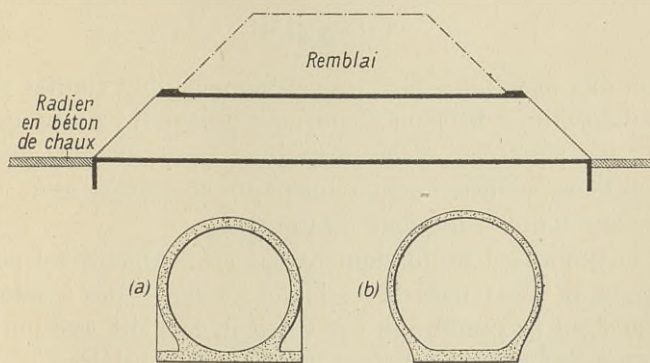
Coupe longitudinale et coupes transversales d'un aqueduc.
